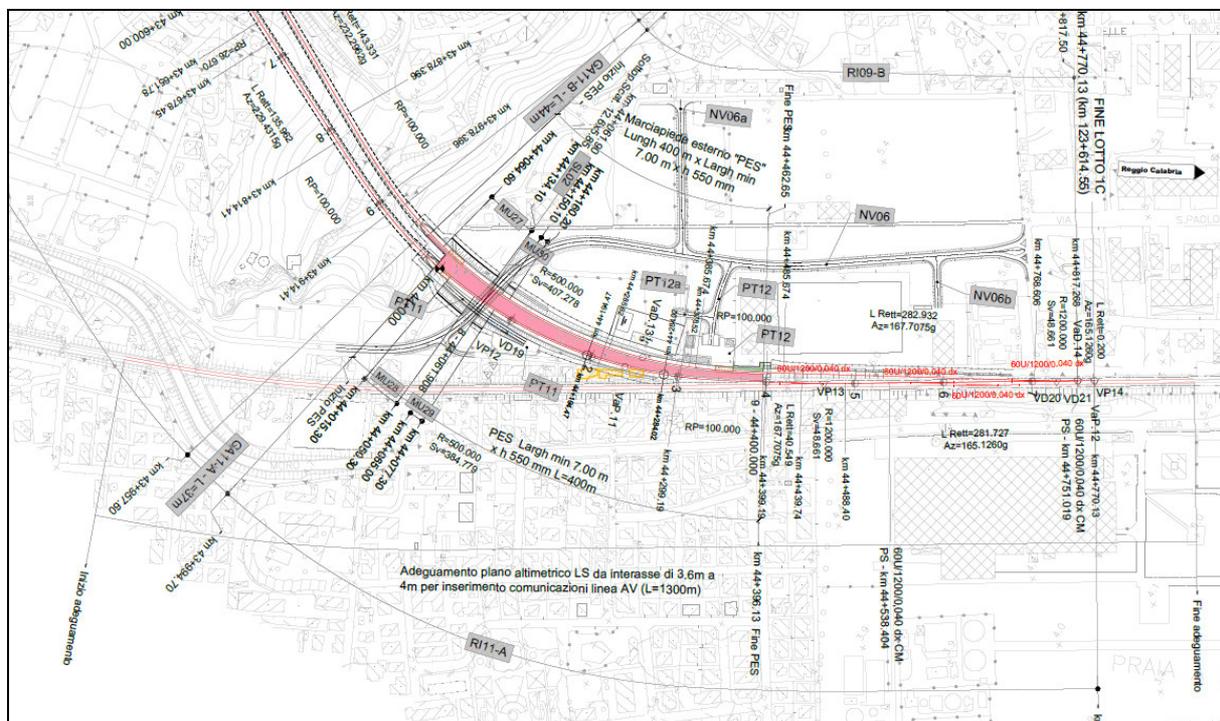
Planimetria di progetto VI05 da km 41+859 al km 44+770 BP
